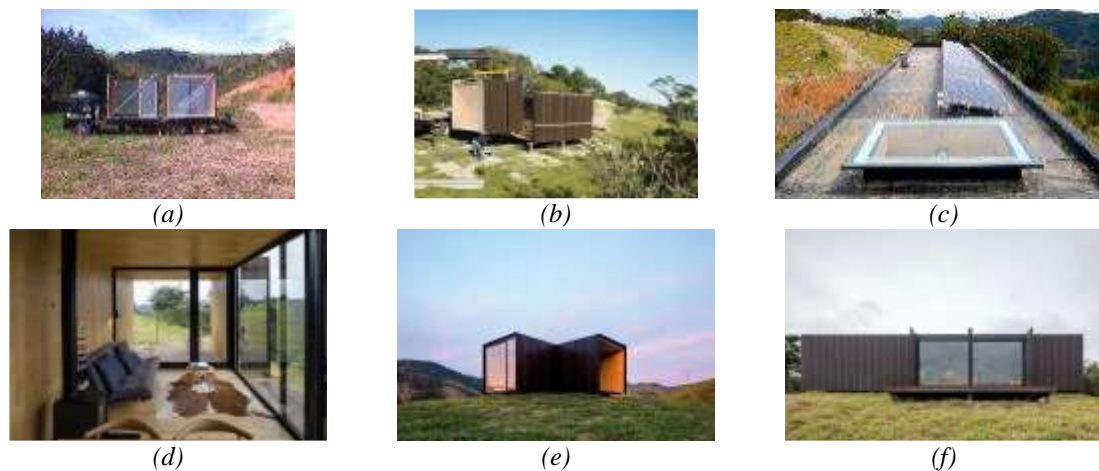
Instalação dos MiniMODs . (a) transporte dos módulos; (b) fixação dos módulos na fundação; (c) impermeabilização e instalação de placas solares; (d) vista interna do MiniMOD linear; (e) vista externa do MiniMOD em cruz; (f) vista externa do MiniMOD linear.
